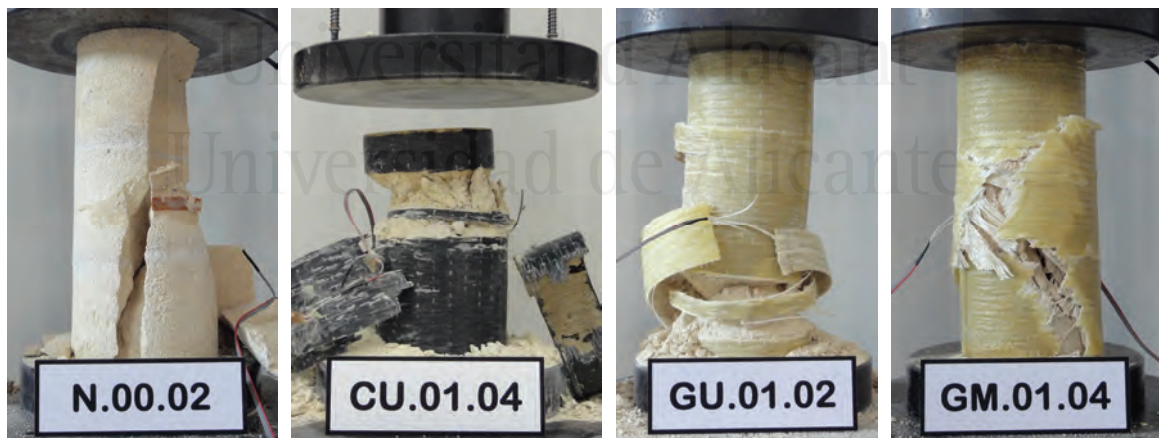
Detalle de rotura de algunas muestras formadas por 3 piezas con juntas de mortero: piezas sin reforzar o con distintas soluciones de confinamiento con FRP.
